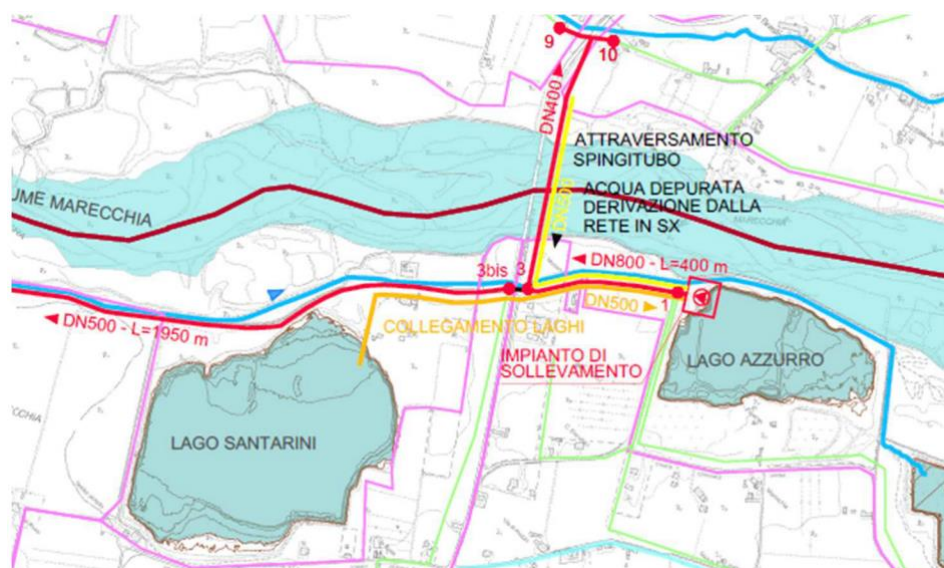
Planimetria di progetto dei laghi del Progetto Definitivo
